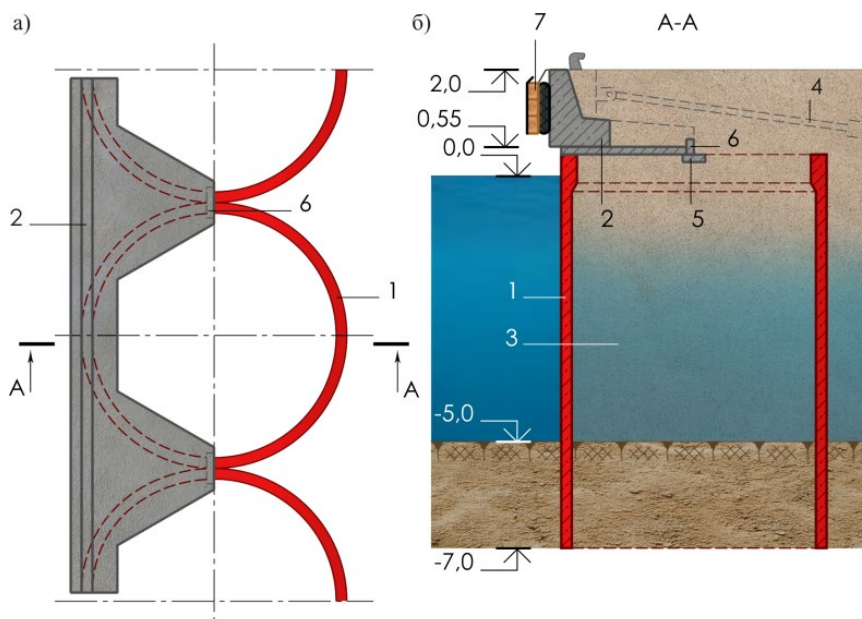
Схема частично заглублённой оболочки в составе набережной в г.Риге (Латвия) [62] а – вид набережной в плане; б – поперечный разрез оболочки; 1 – железобетонная оболочка, 2 – верхнее строение, 3 – наполнитель (песчаный грунт), 4 – анкерные тяги, 5,6 – элементы верхнего строения, 7 – отбойные устройства
